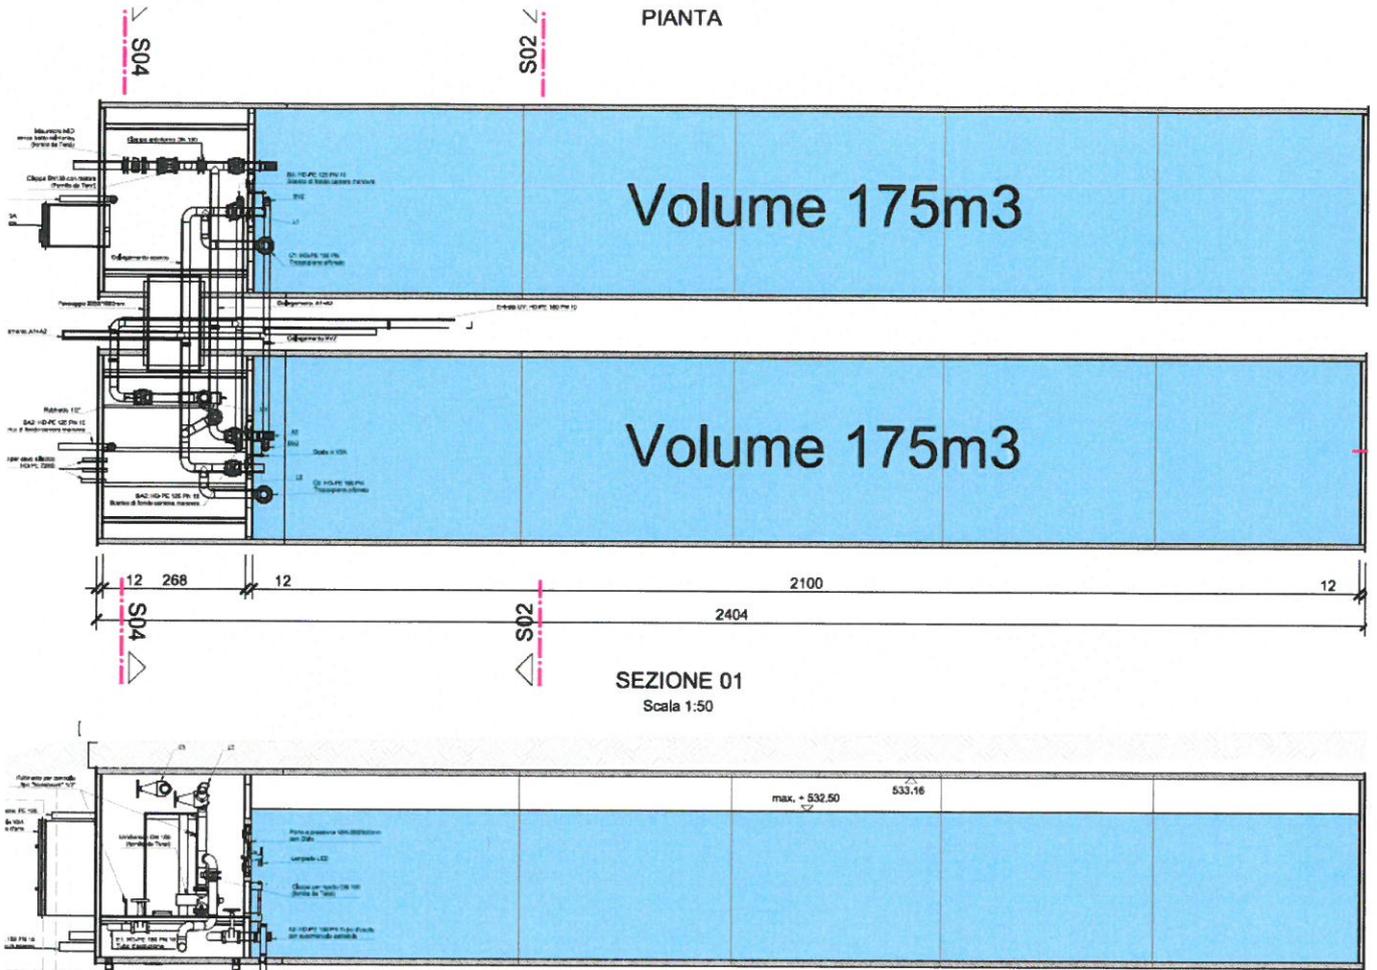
Pianta e sezione longitudinale del serbatoio
